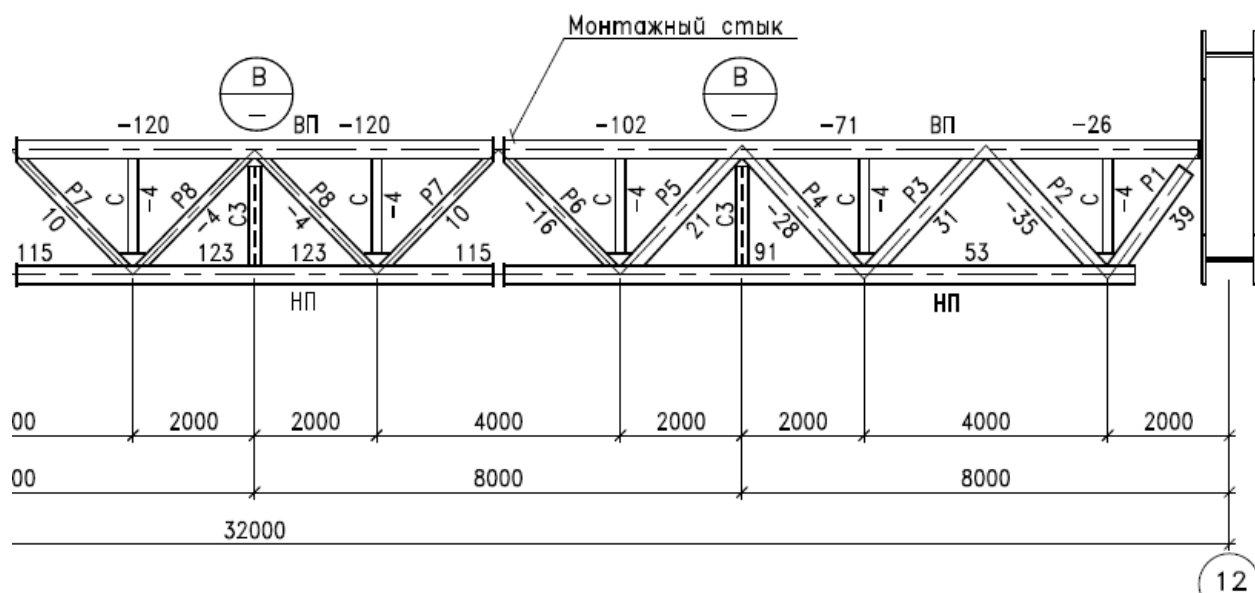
Фрагмент фермы с указанием усилий по элементам фермы
